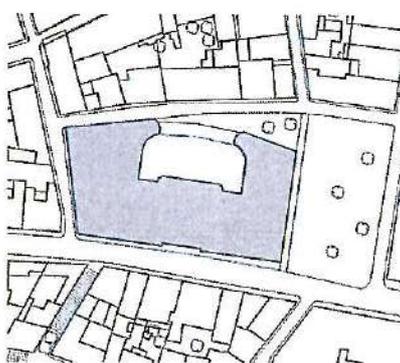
Planta de Implantação da Segunda Versão | Escala 1:2000
